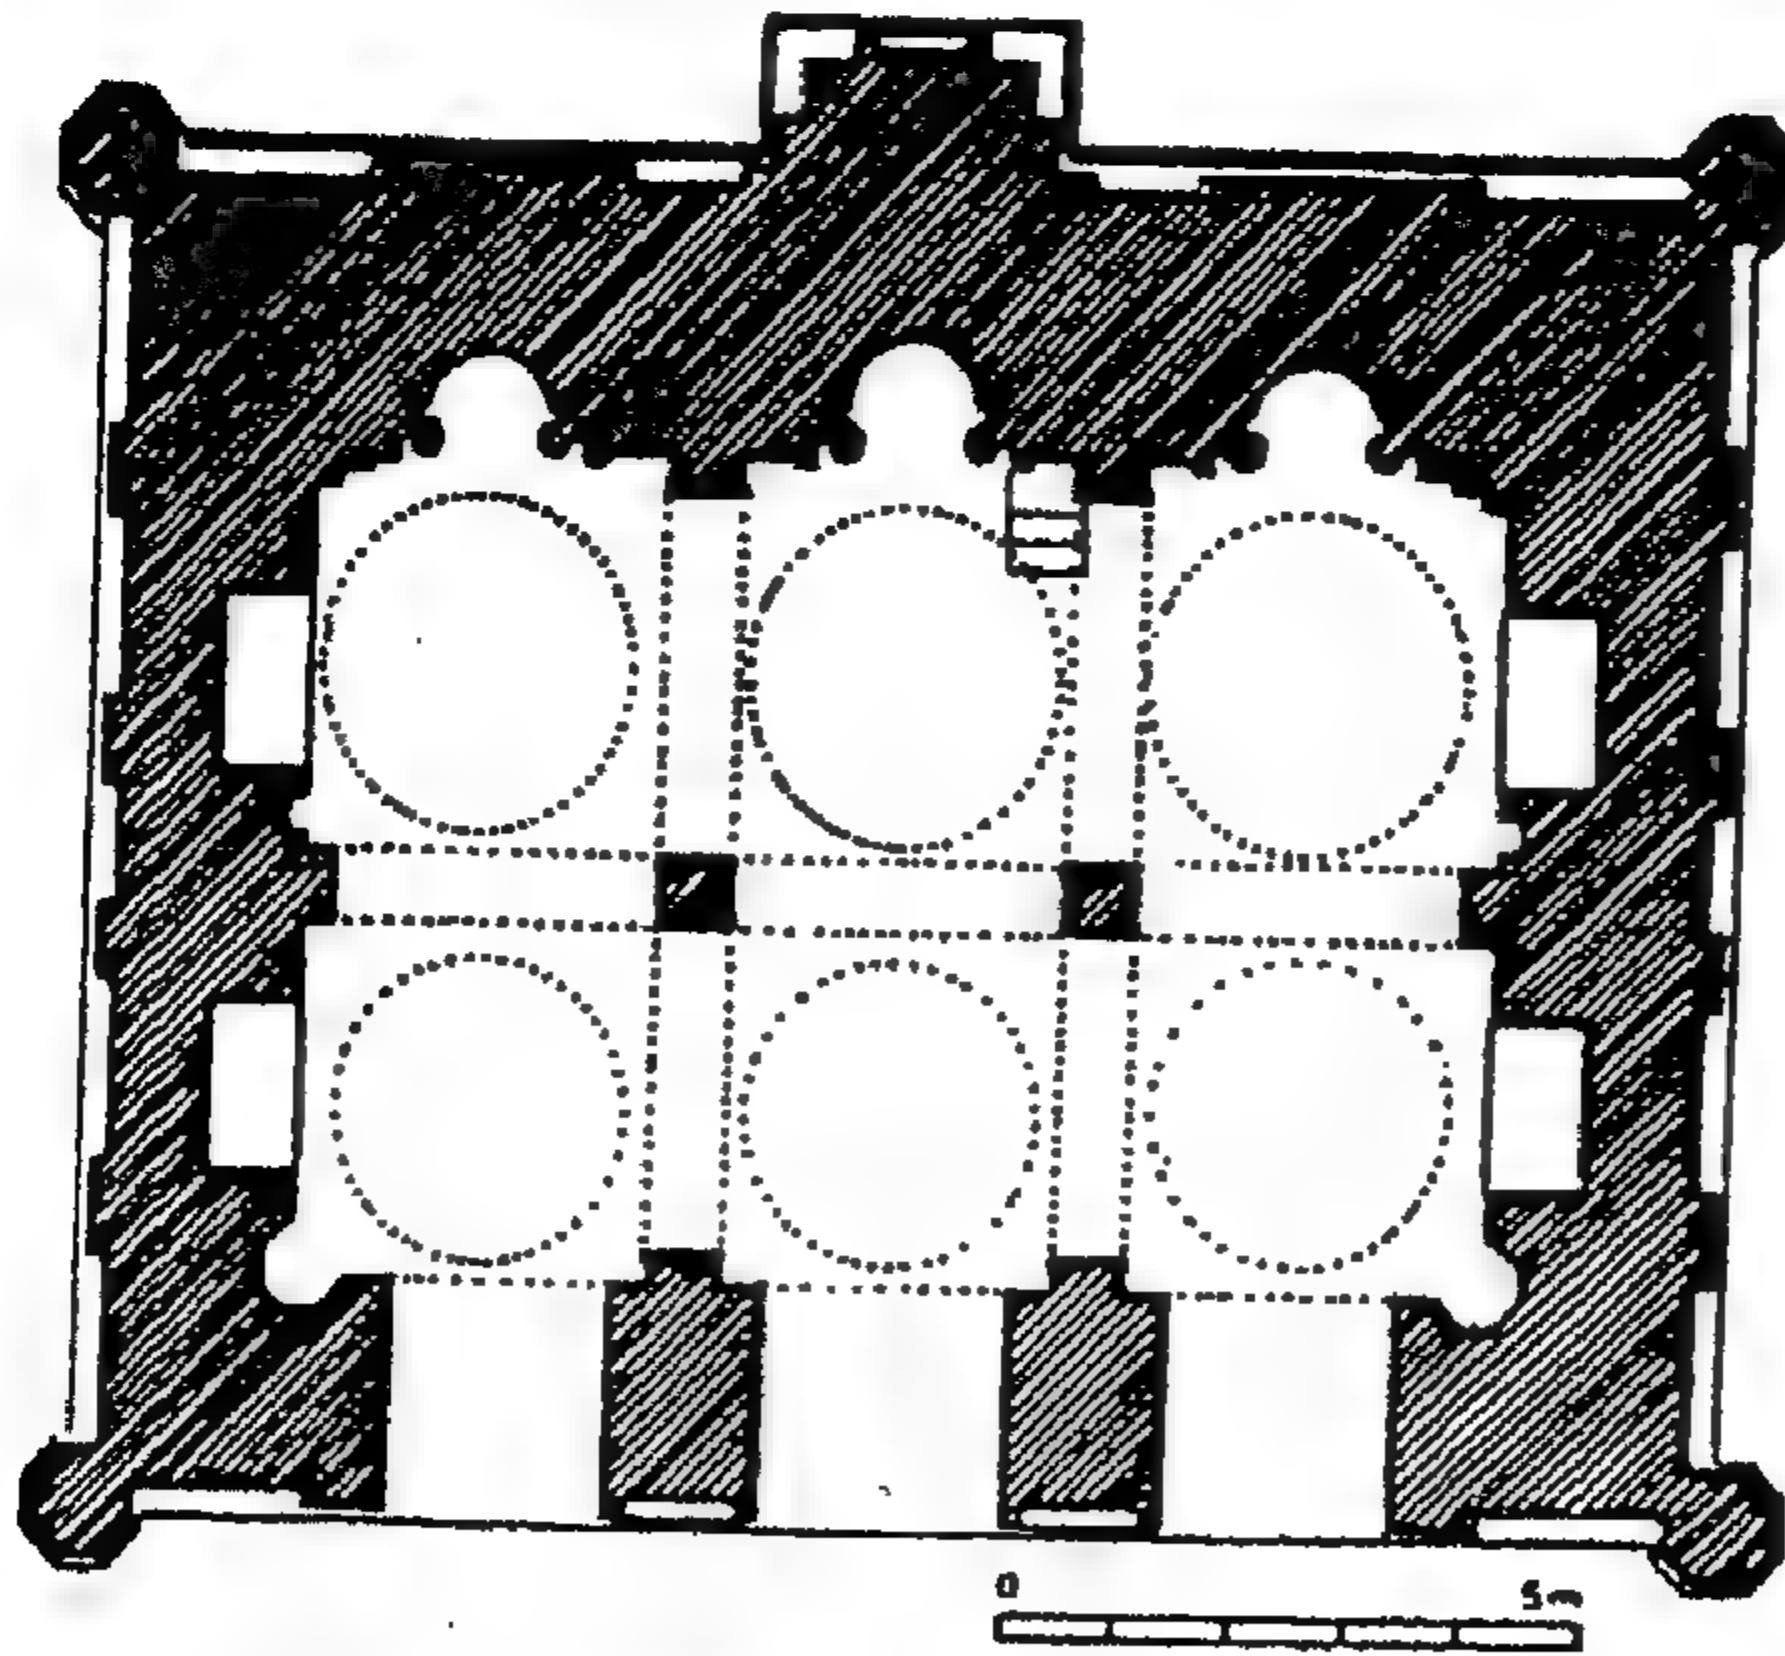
مسقط أفقي للجامع العتيق أو القديم في ادرنه .
